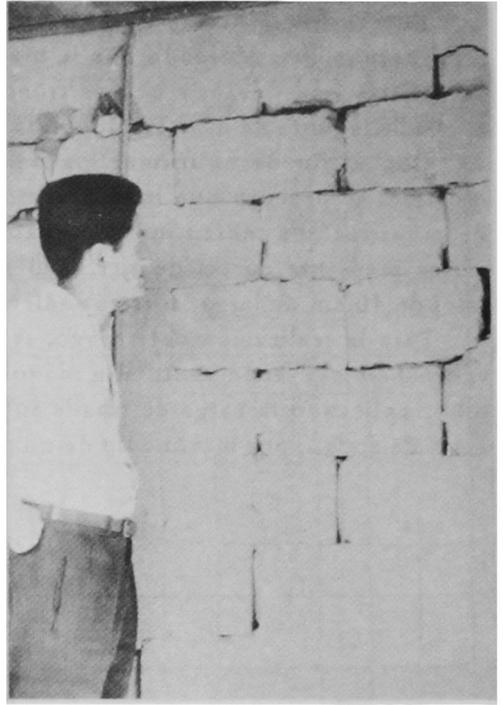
Grietas producidas en un muro interior divisorio. Población Pedro Aguirre Cerda.
